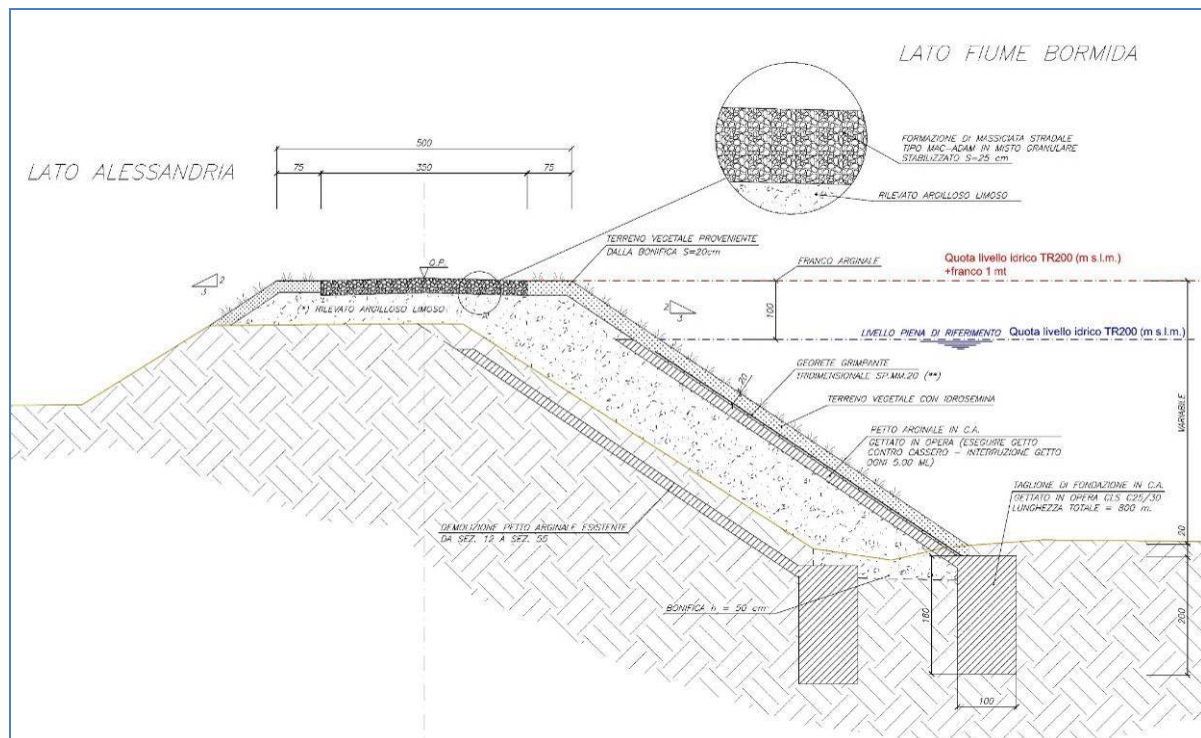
Argine sinistro, opera 5 - sezione trasversale tratto sezione 12 - sezione 56
